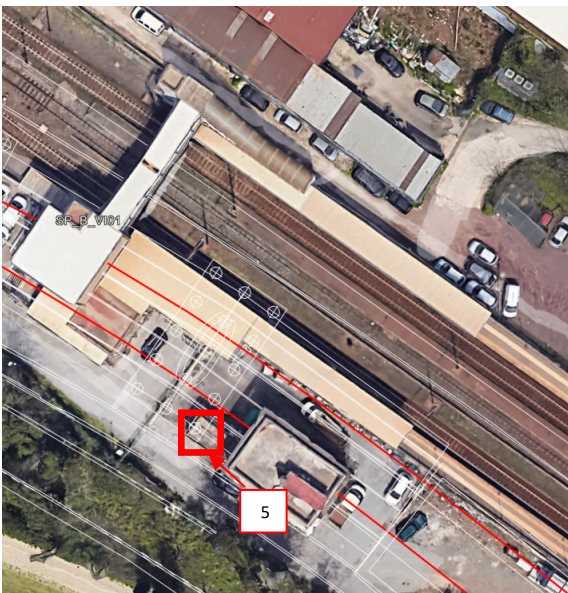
Stralcio planimetrico su ortofoto - Opera civile 5
